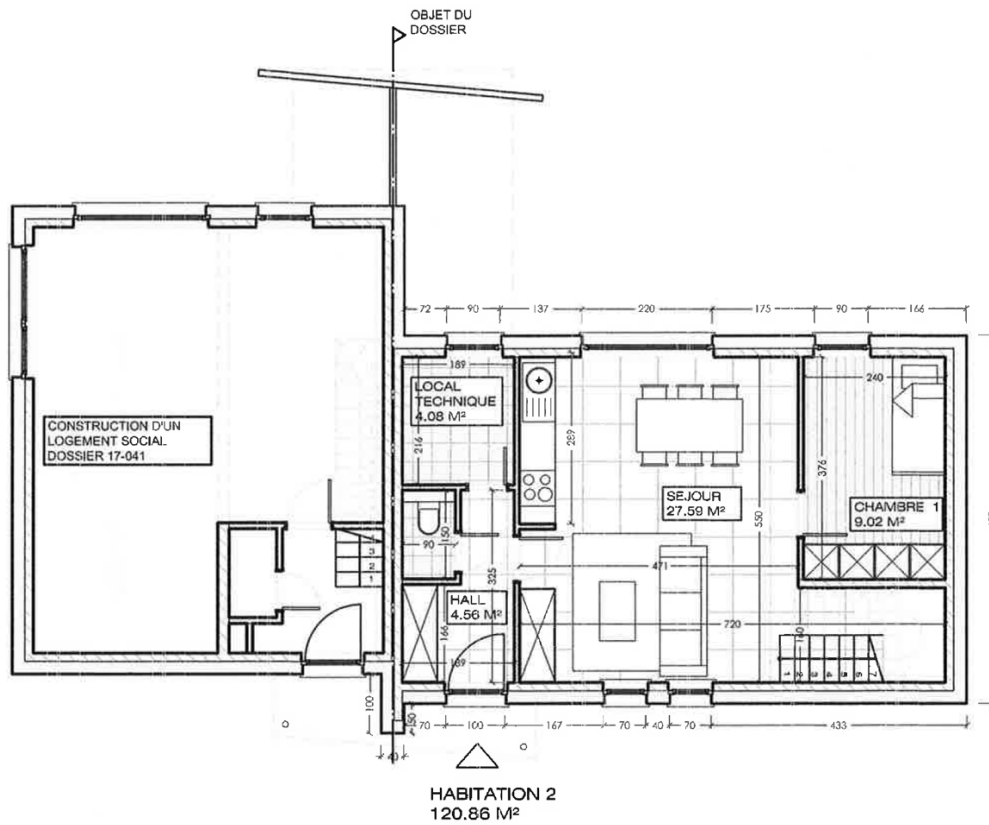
Plan du Rez-de-chaussée du projet de logement d'urgence (RUIDANT, 2017)
